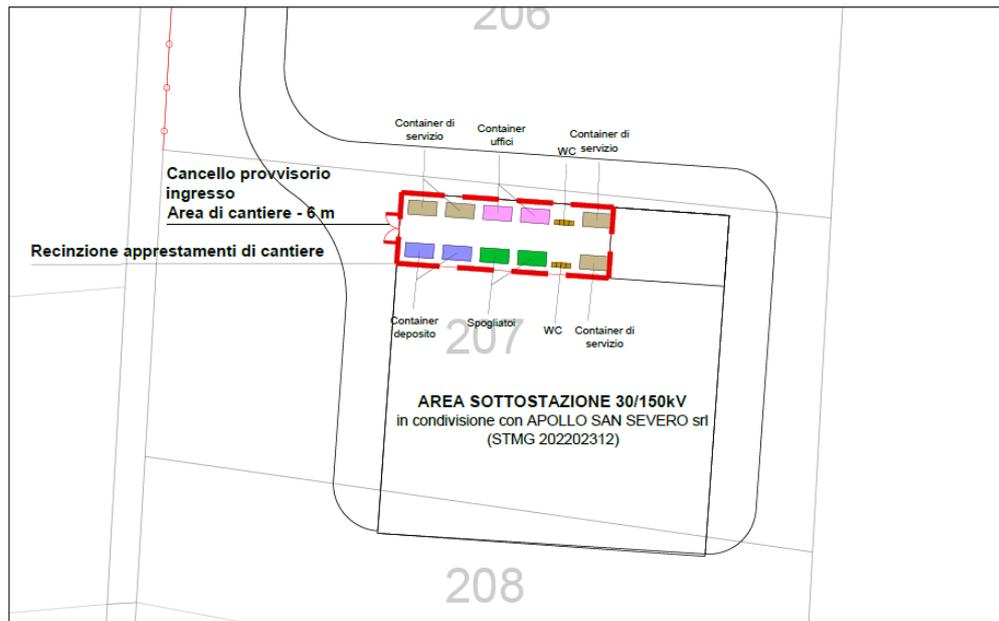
Area di cantiere interna all'area della Stazione di elevazione
